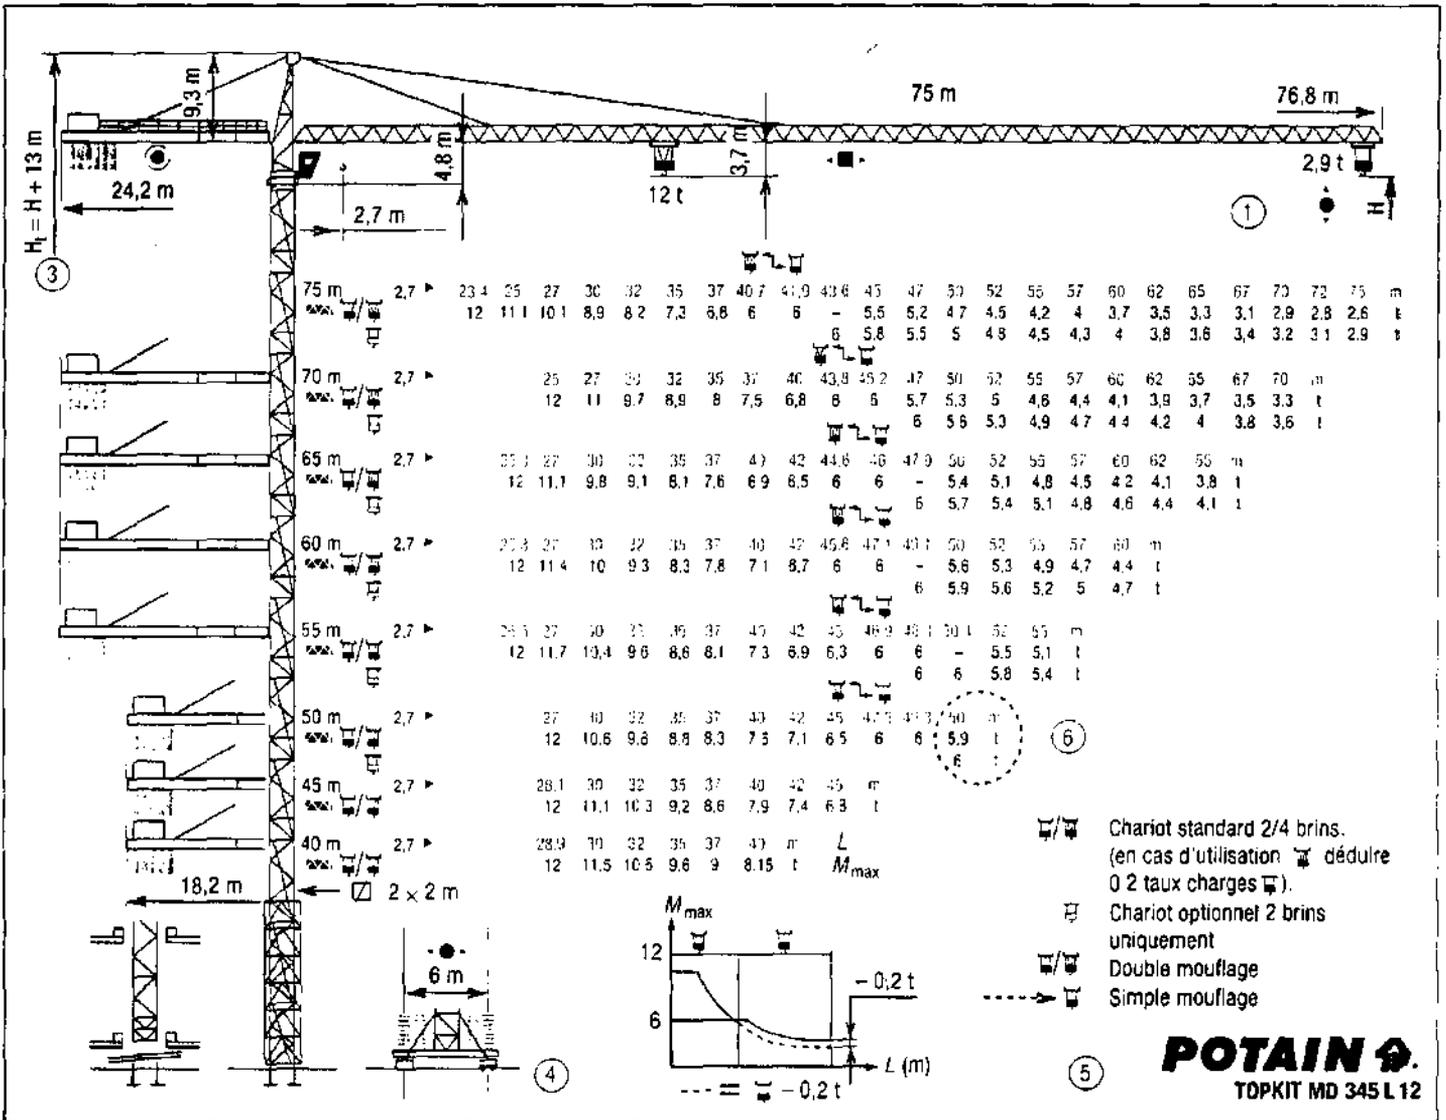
Caractéristiques dimensionnelles et courbes de charges.
